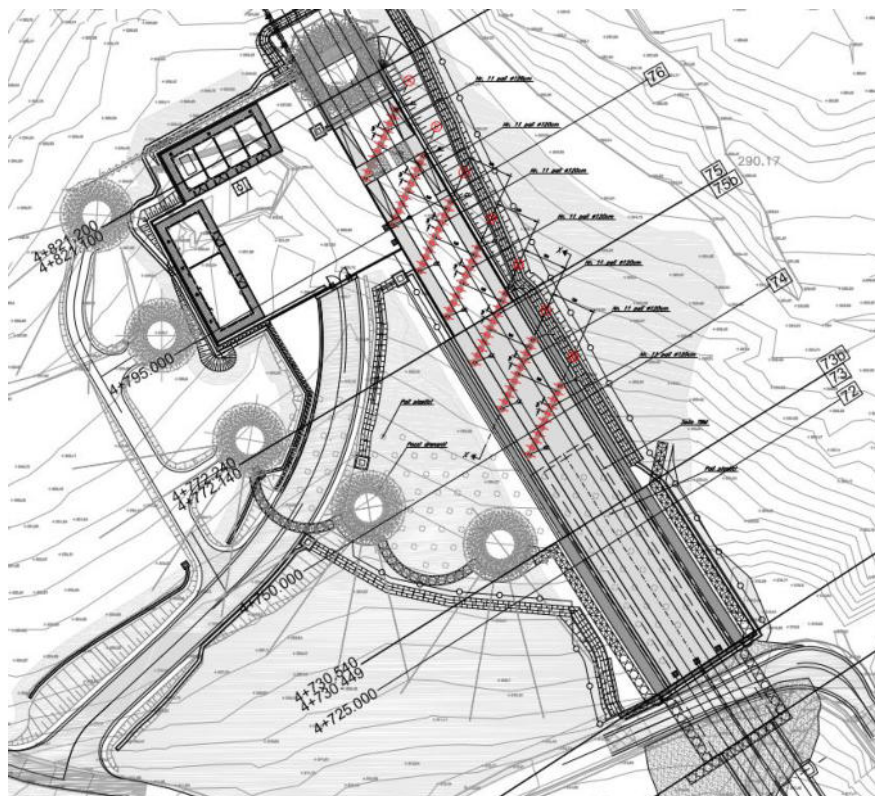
Interventi di mitigazione nel tratto tra imbocco GN01 e Spalla A Viadotti VI02
